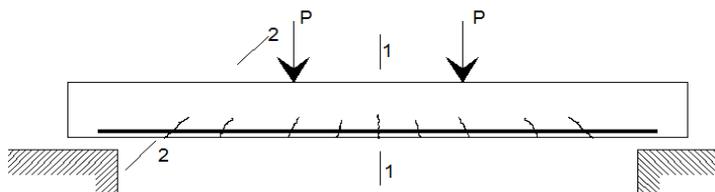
Образование трещин и разрушение балки по нормальному (1) и по наклонному (2) сечениям.
